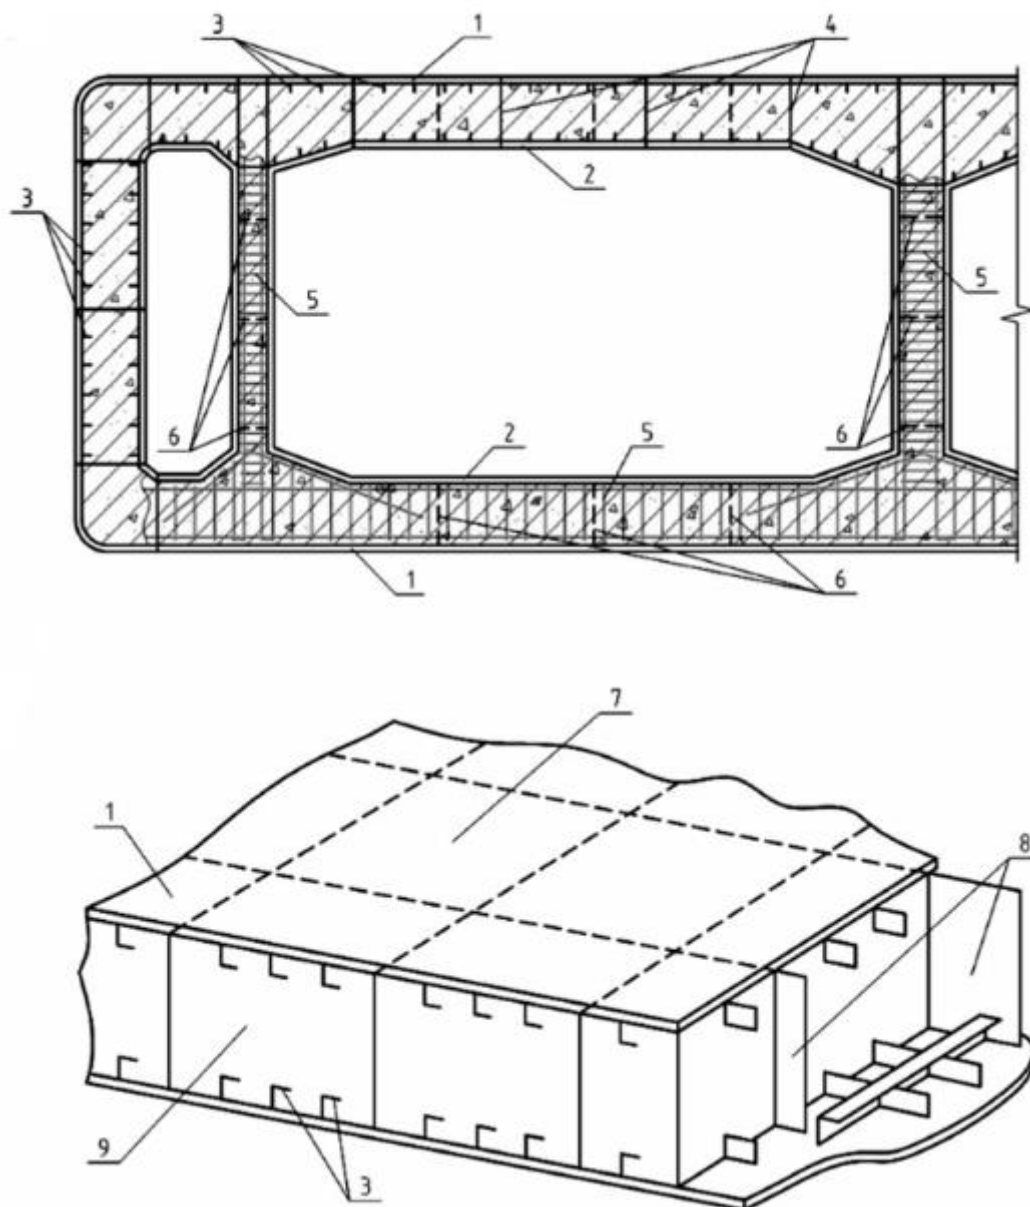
Поперечное сечение сталебетонной тоннельной обделки
